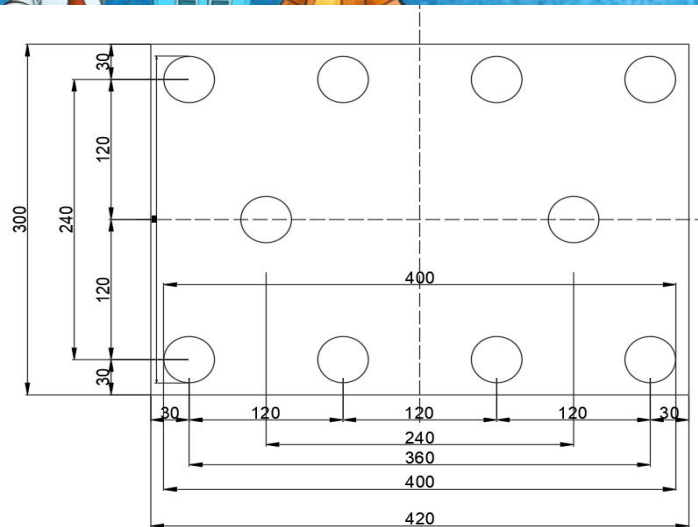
Расчётная схема к расчёту осадки фундамента
